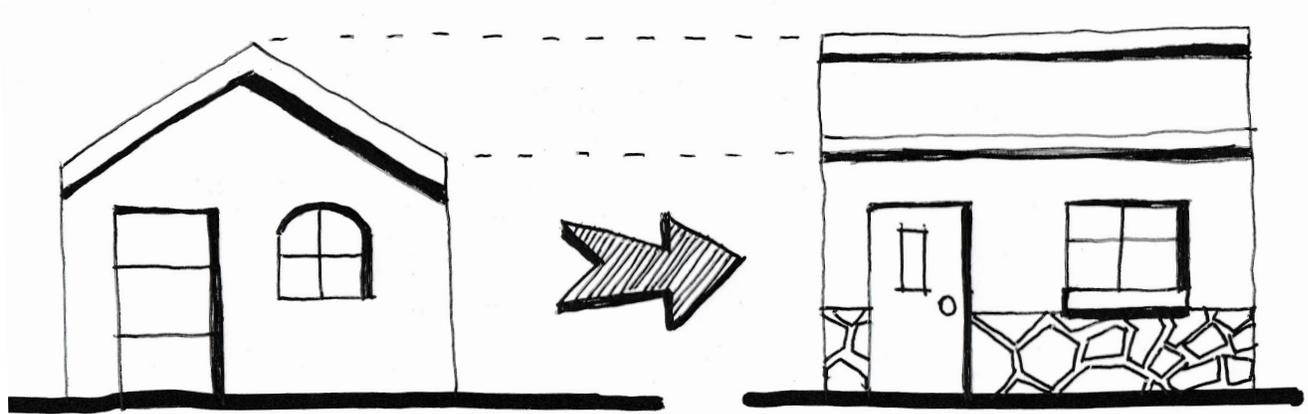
Esquema que ejemplifica la intervención a fachadas no originales. Elaboración: propia
